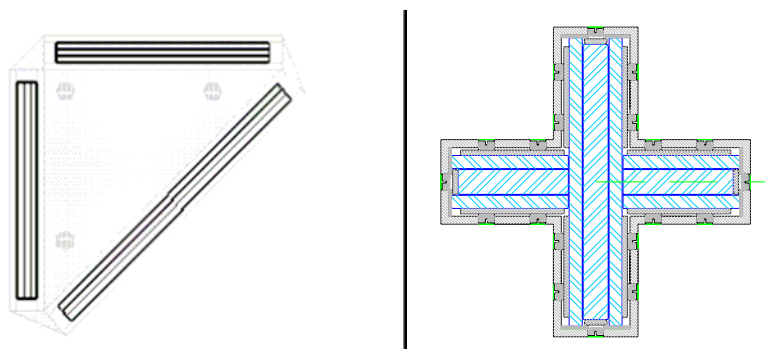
Sezioni di pilastrì: a sezione aperta e a croce con basamento
